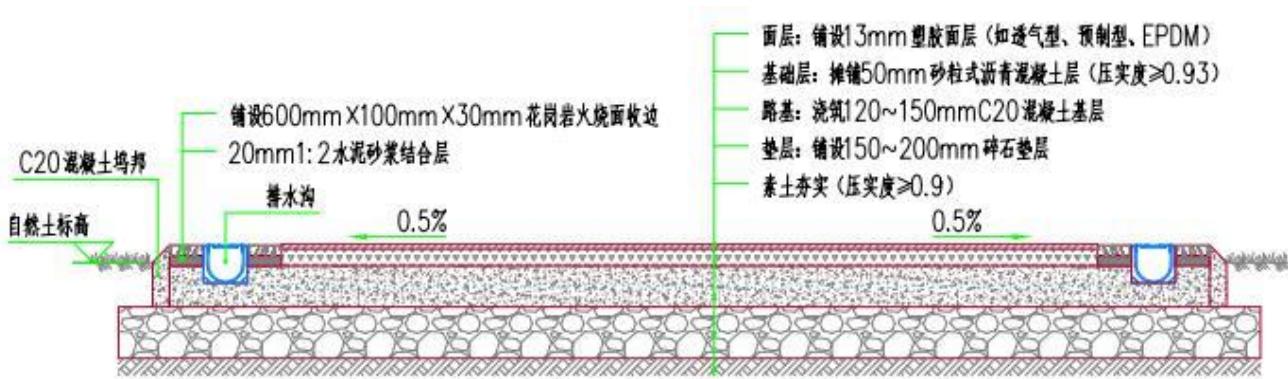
彩色沥青混凝土健身步道参考平面图（单向标准段）
